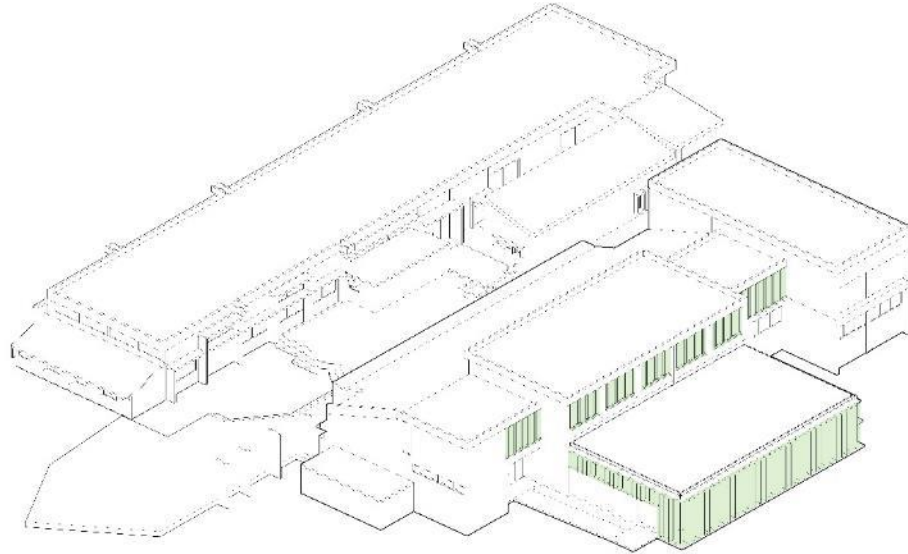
Ubicación de la envolvente propuesta en la edificación.
